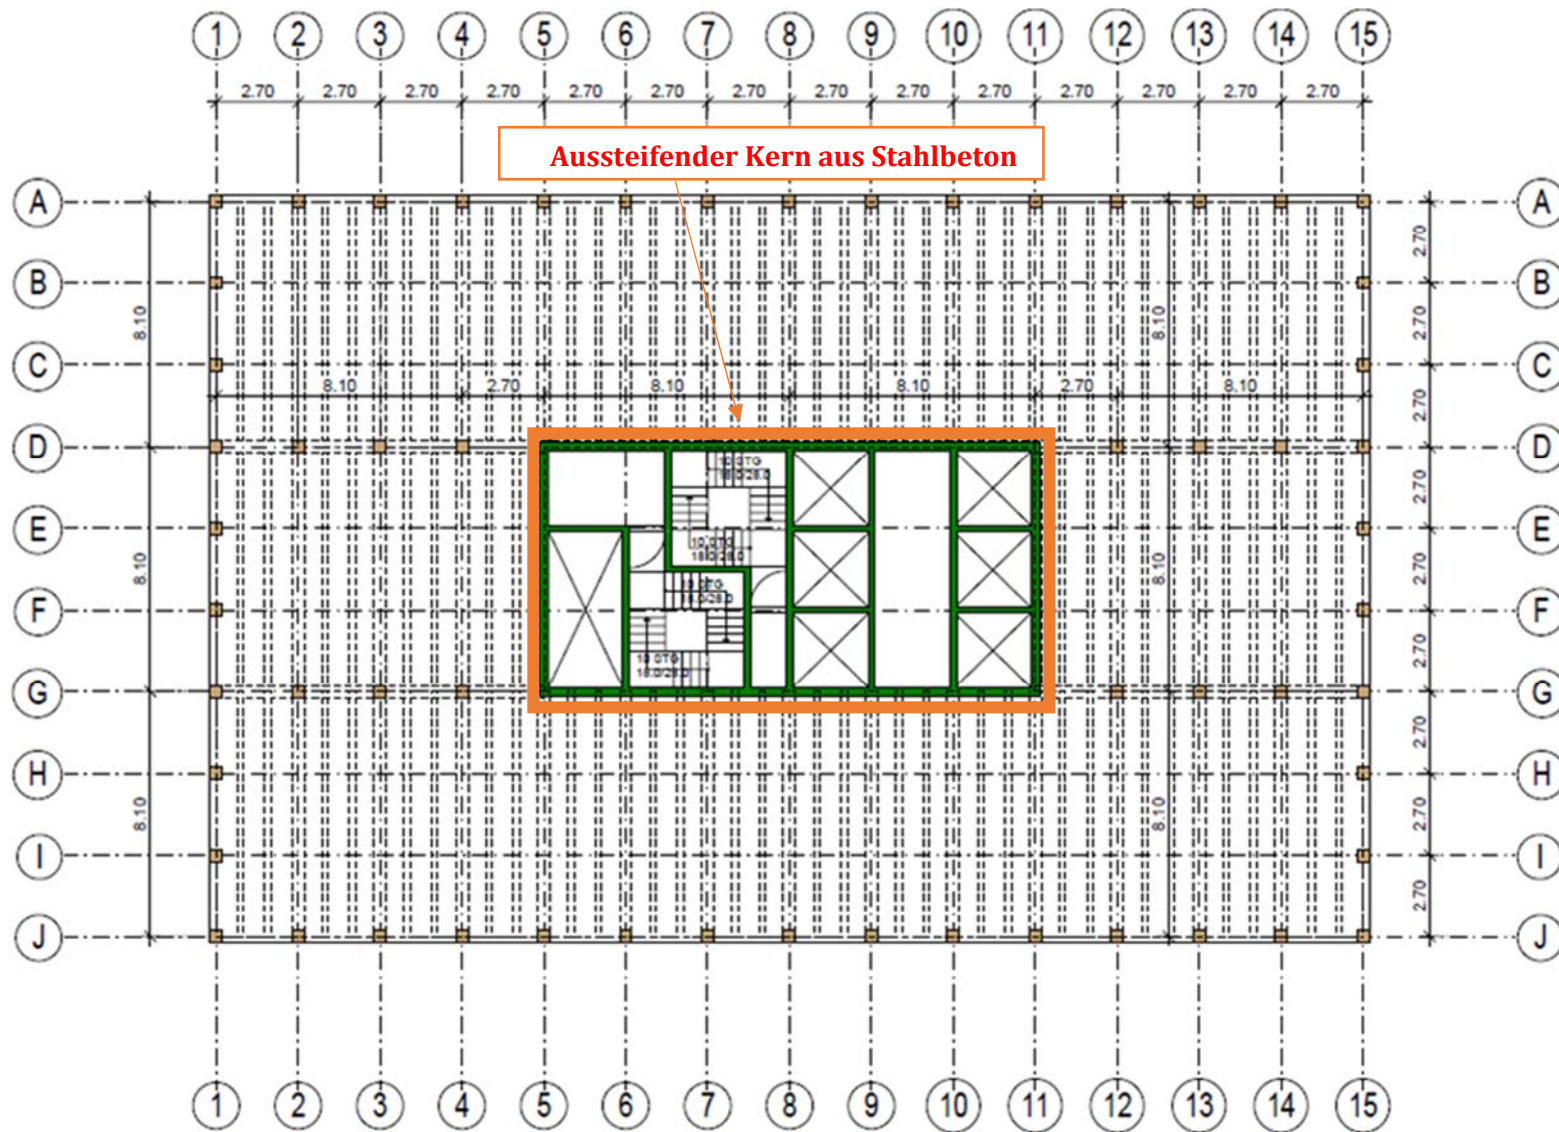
Grundriss Tragwerkstyp 1
